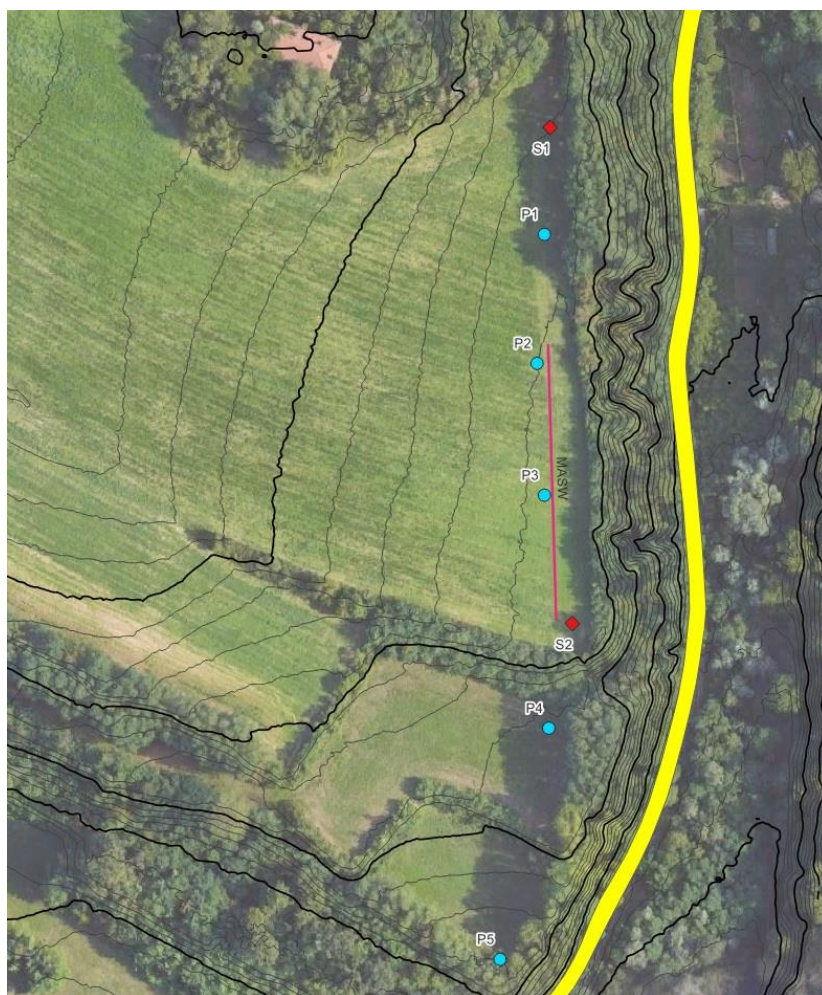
Planimetria con ubicazione delle indagini geotecniche
